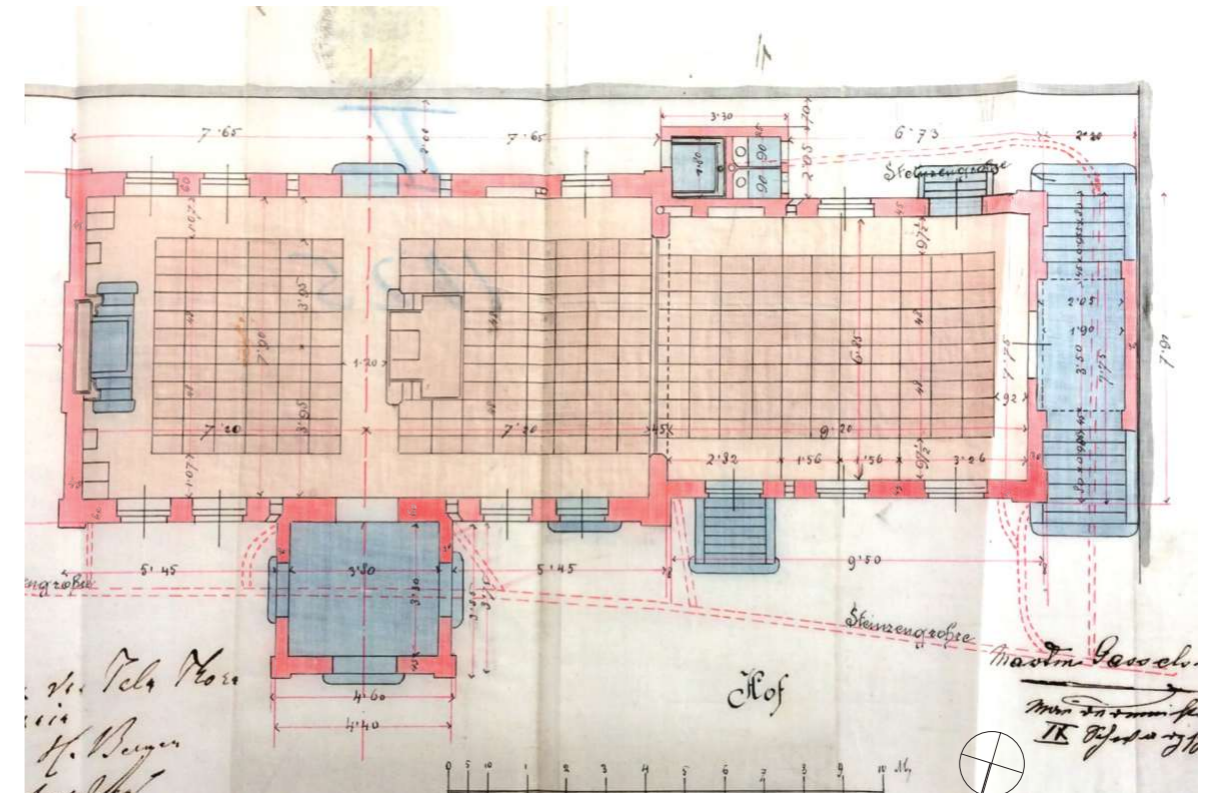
Grundriss Auswechslung (1884) [ma37]
